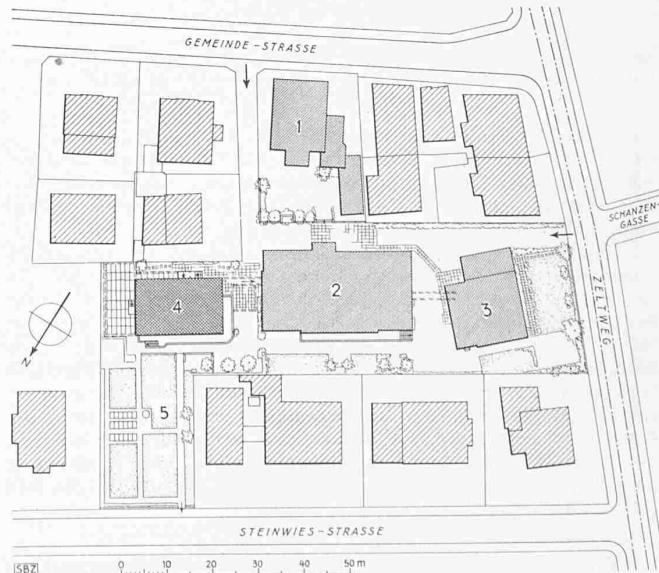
Haushaltungsschule Zürich. Lageplan 1:1500. — 1 Haus Morgenthal, 2 erstes Schulhaus, 3 Logierhaus, 4 neues Schulhaus, 5 Schulgarten
